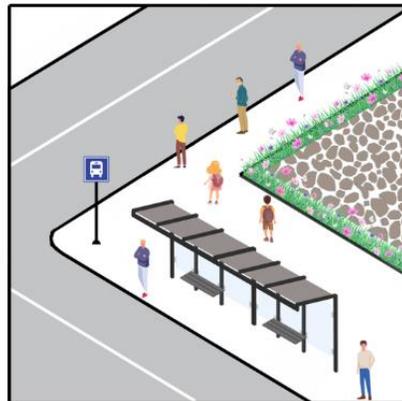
Propuesta de paraderos en la Calle 22 esquina con Calle 21
